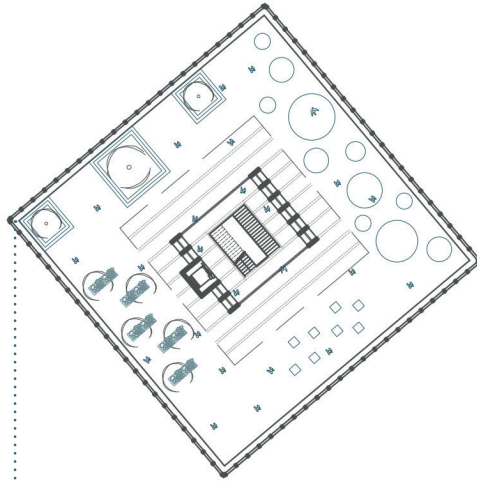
Plan Toit - 1.500 - Continuité de la cour en toiture, les espaces de jeu
